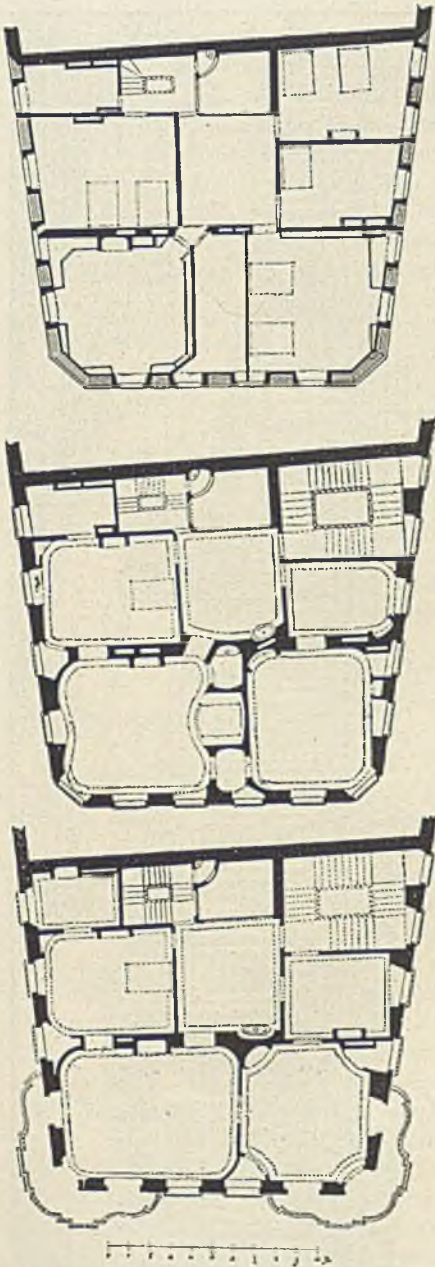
Grundriß dreier Geschosse der Maison Bréthous zu Paris
